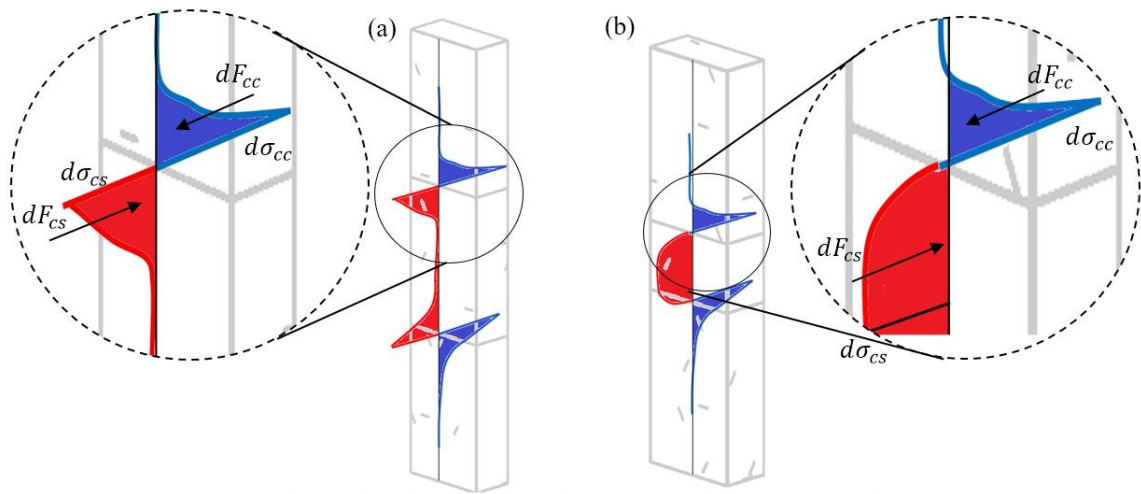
Distribuição de tensões de tração e compressão ao longo da altura do pilar
